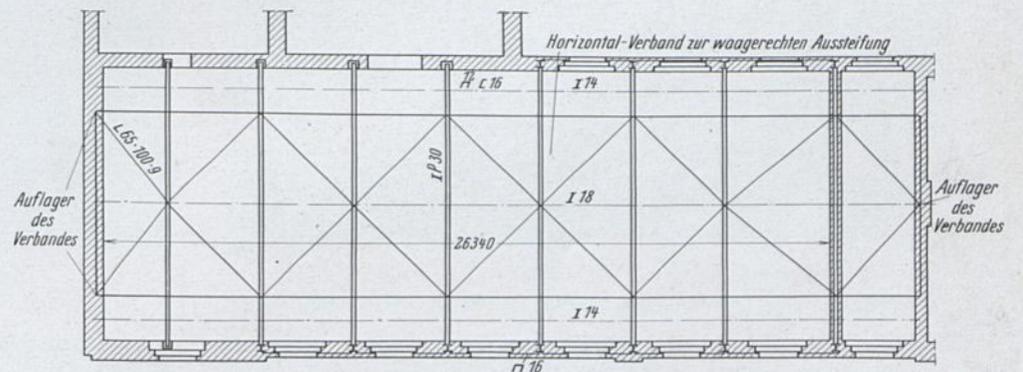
Theatersaal des Propagandaministeriums. Grundriß.
